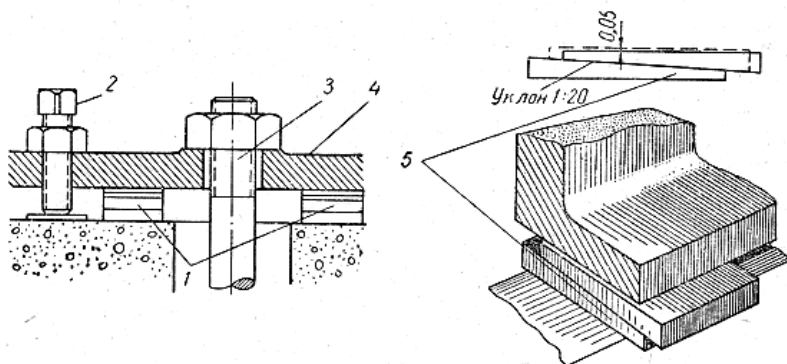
Приспособления для выверки оборудования на фундаментах:
